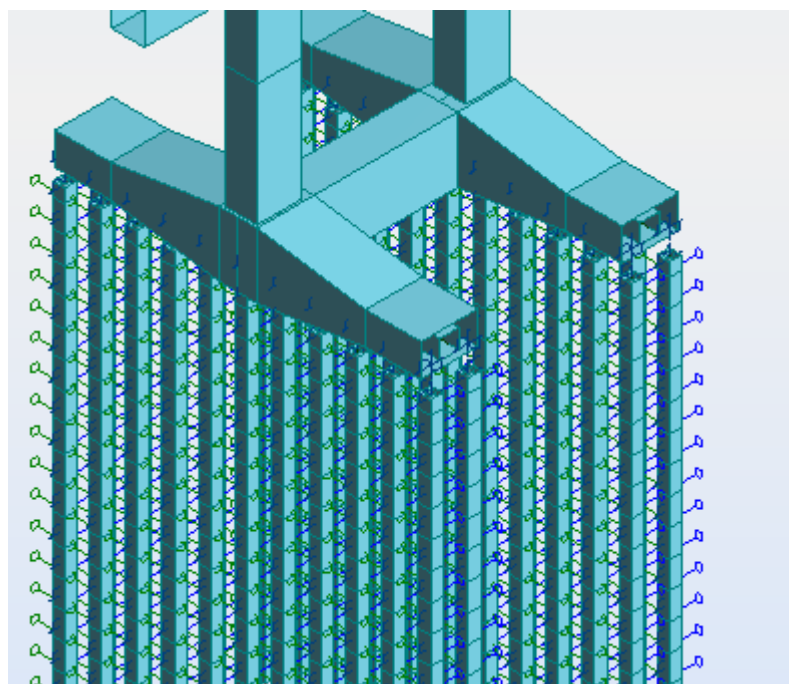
Detalhe da modelação da rigidez transversal do solo
